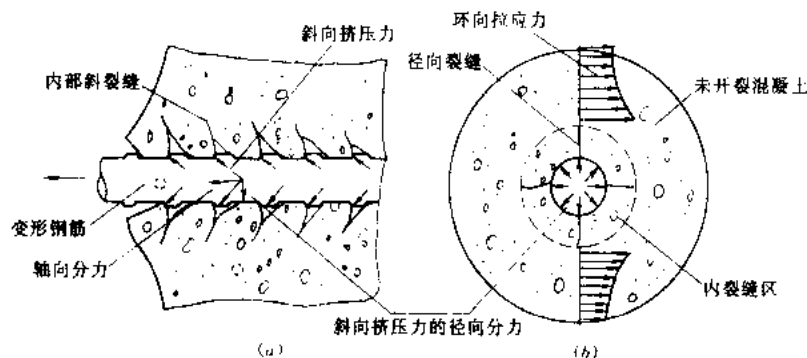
变形钢筋外围混凝土的内裂缝
